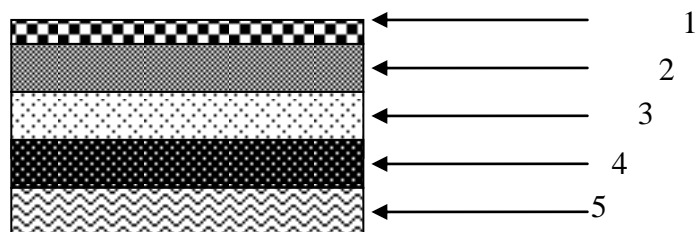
Coupe verticale du balcon en dalle pleine
